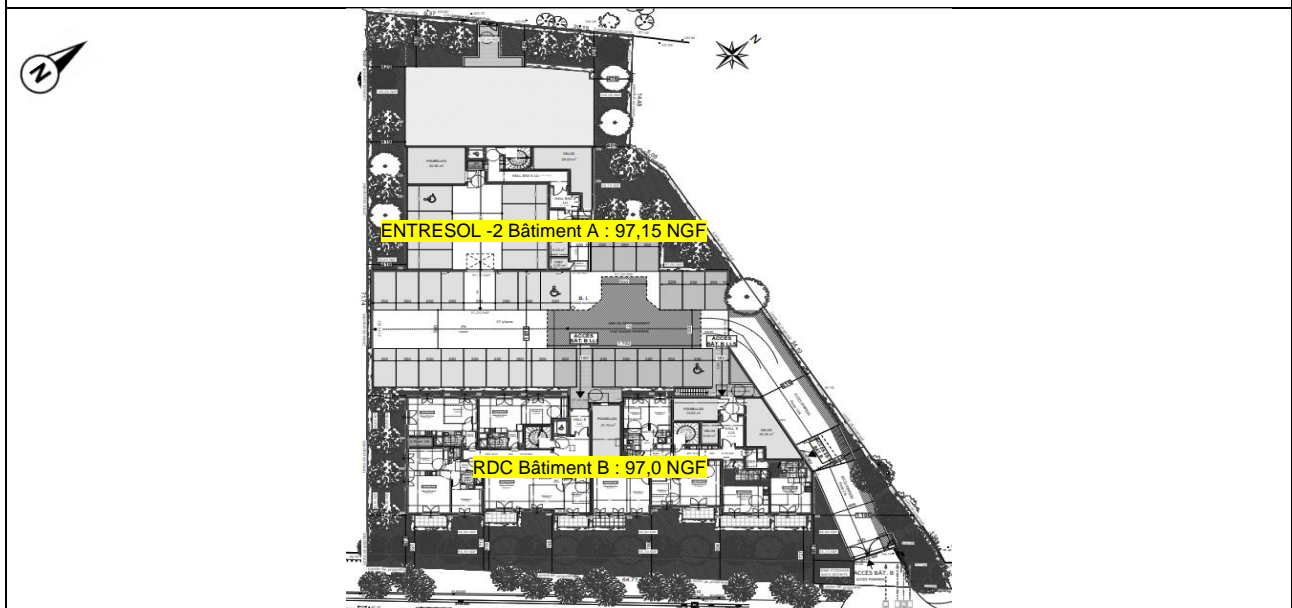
Extrait du plan RDC bâtiment B et parking entresol-2 bâtiment A à l'échelle de 1/200^{ème}, daté du 15/12/2023
